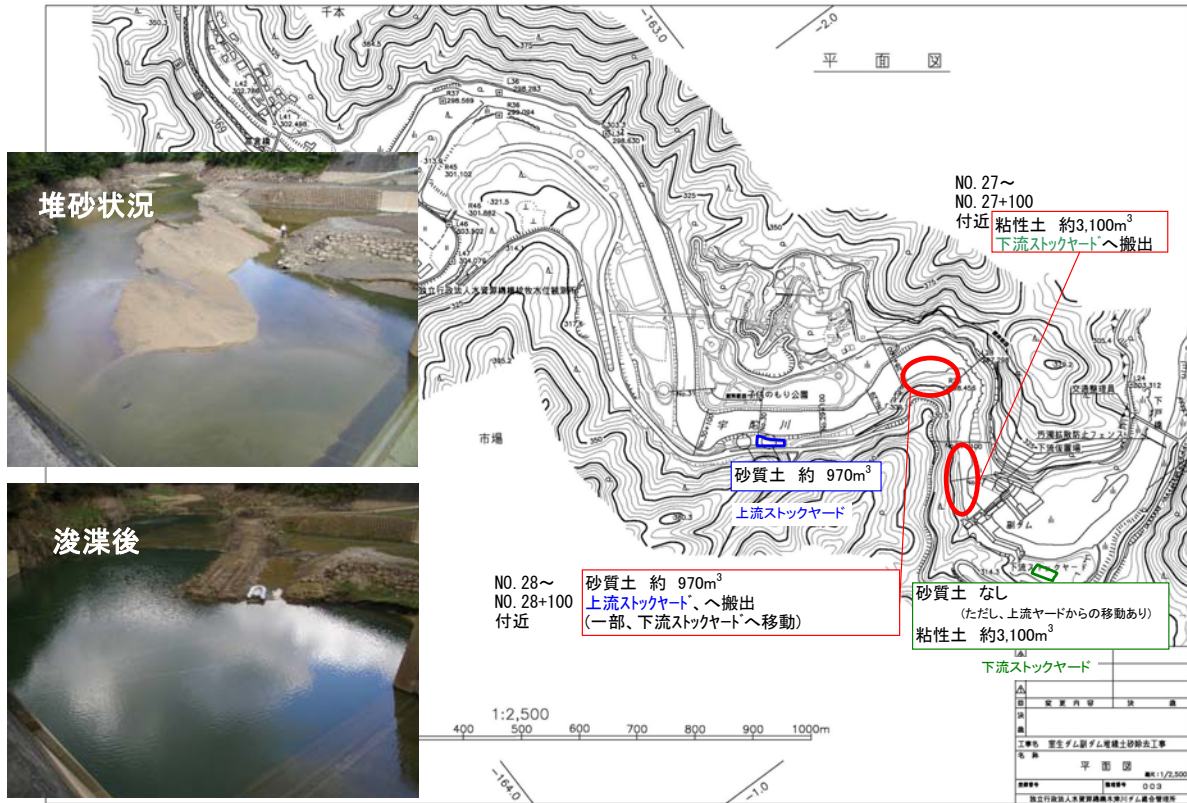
2007(平成 19)年度浚渫工事箇所平面図
